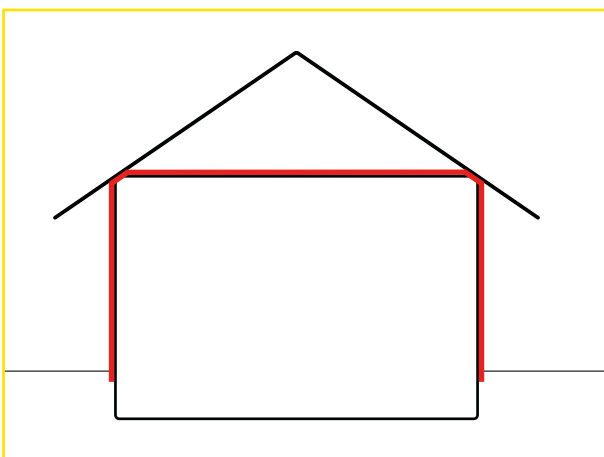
Aufbau Fassade außen & Dach innen (Dachboden)
